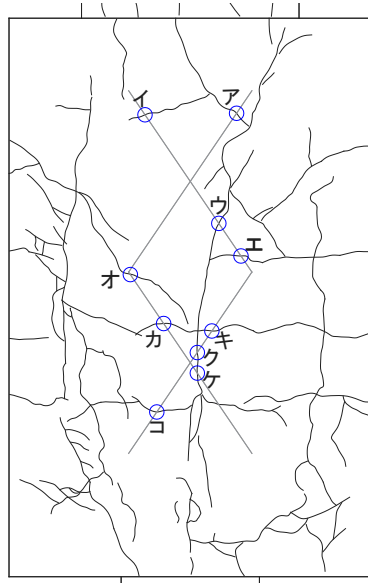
パイルキャップひび割れ幅測定位置 (試験体 B-1 負荷荷)
